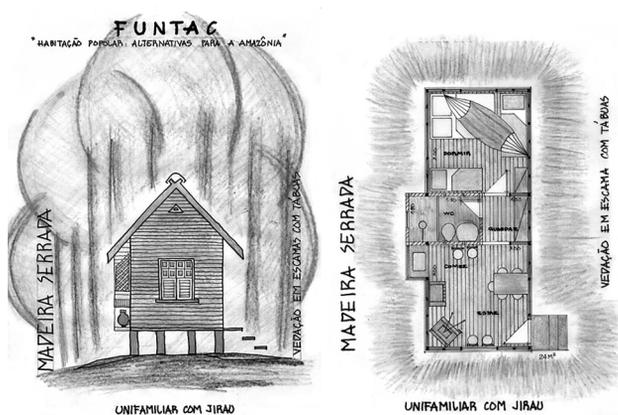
Madeira serrada para área urbana – fachada e planta baixa
